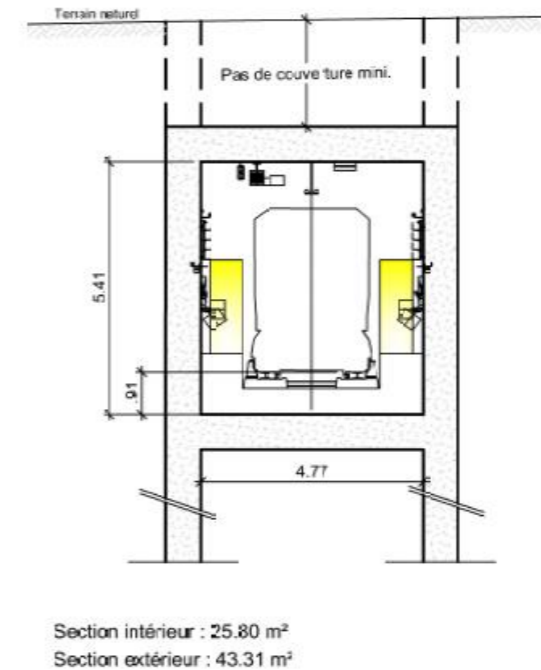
Coupe-type du tunnel en section tranchée couverte
